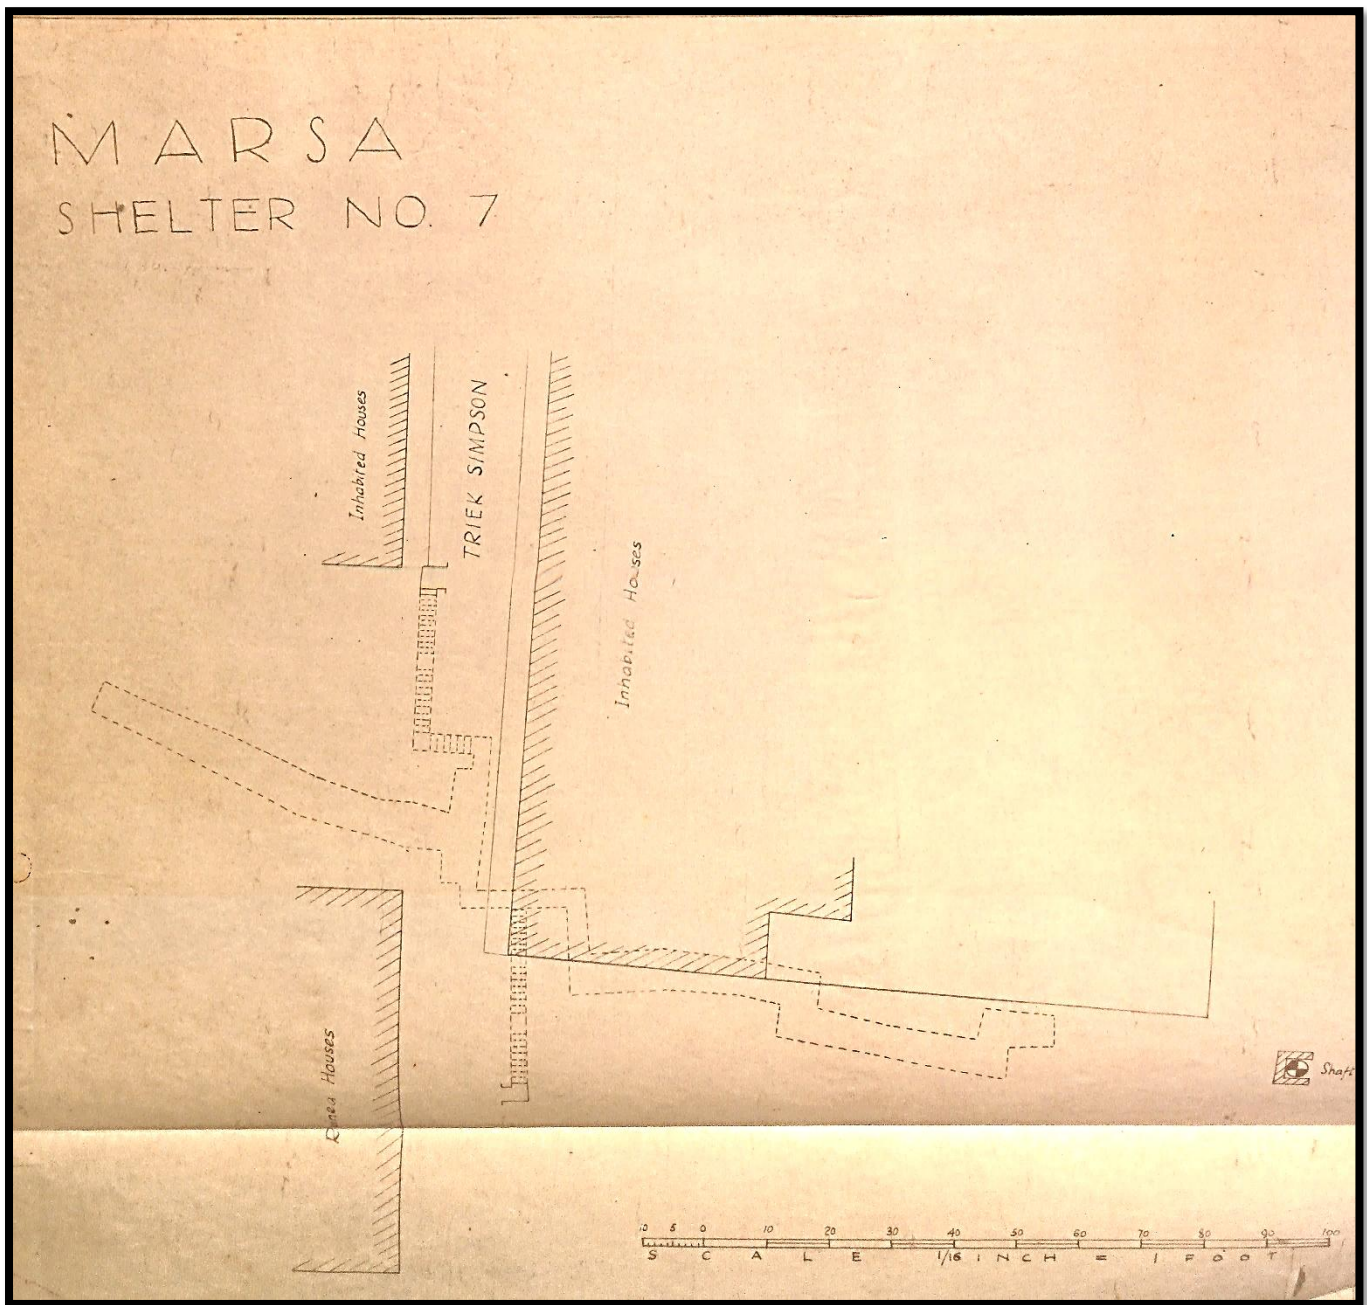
Planta do Abrigo nº7 "Trek Simpson"
